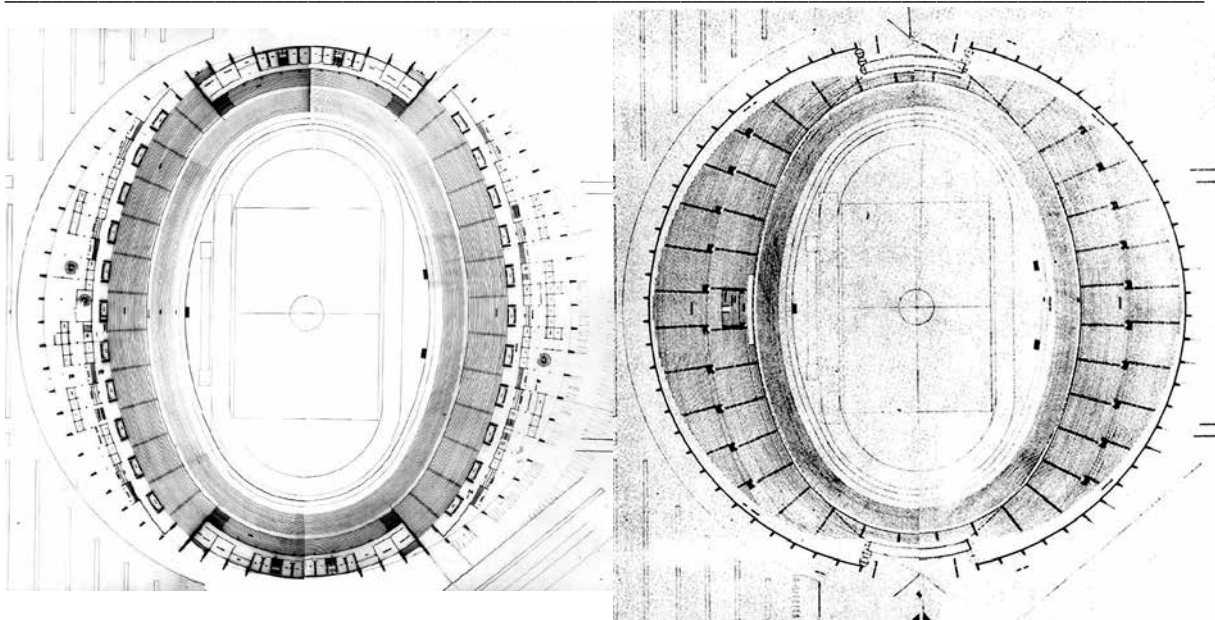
1º prêmio concurso Estádio Pinheirão: planta nível terreno; Fig.617: planta nível superior.
